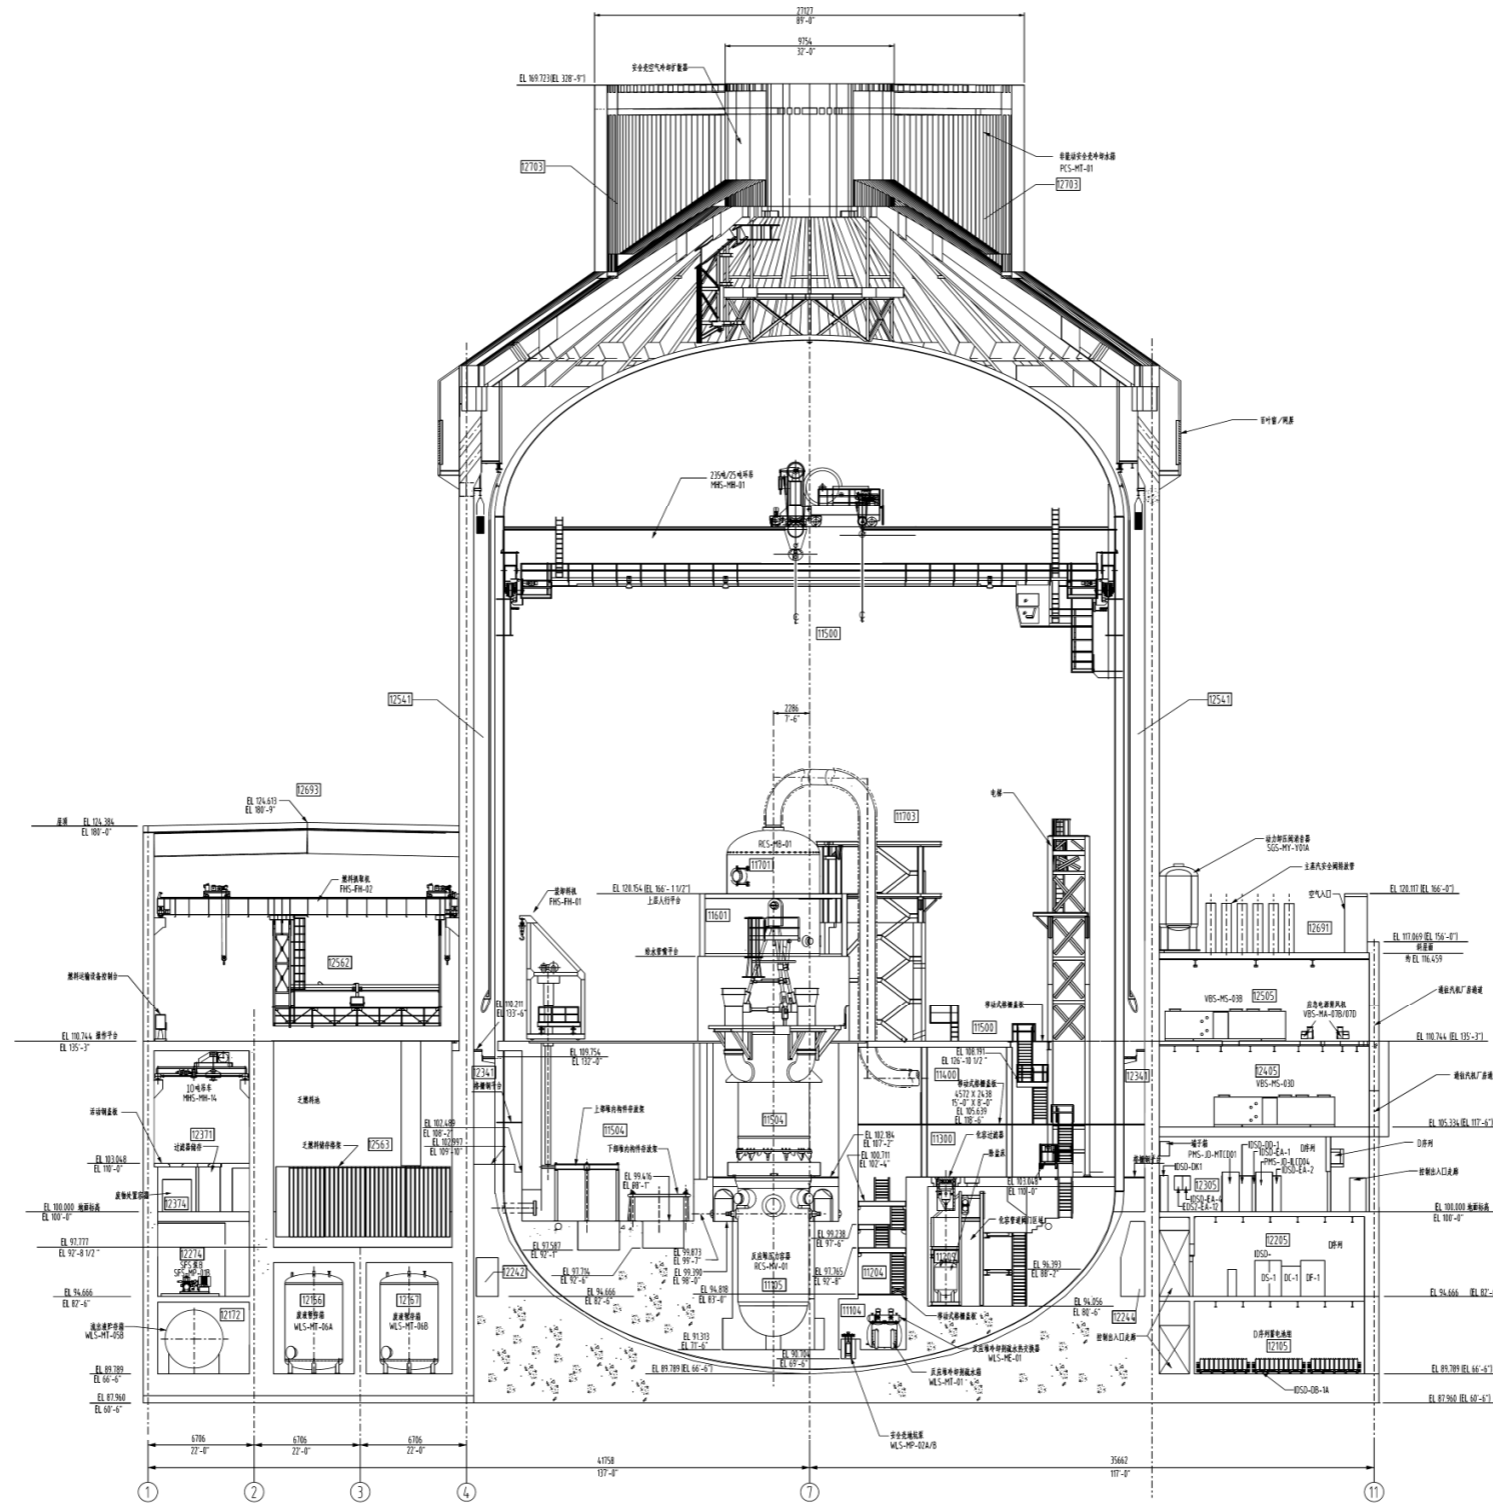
核岛厂房布置示意图 A-A 剖面
